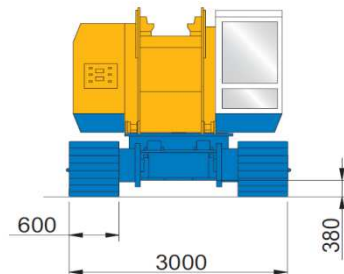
Schéma vrtné soupravy BAUER 15H (BT 40) - boční pohled
